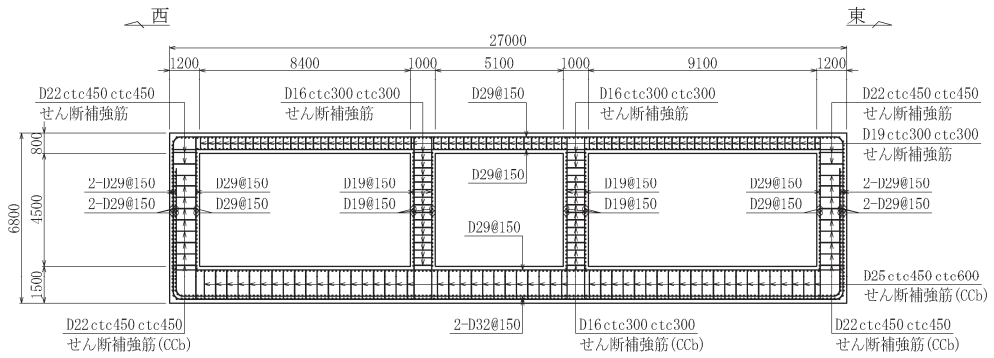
軽油タンク室概略配筋図 (C-C 断面, 東西 (ポンプ室))
